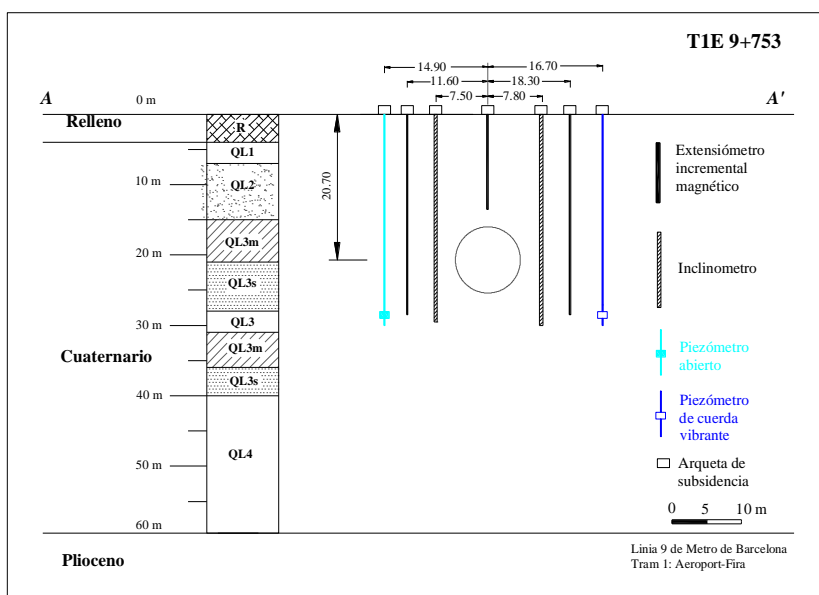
49. Perfil topográfico de la sección de control TIE PK 9+753 y la instrumentación instalada
